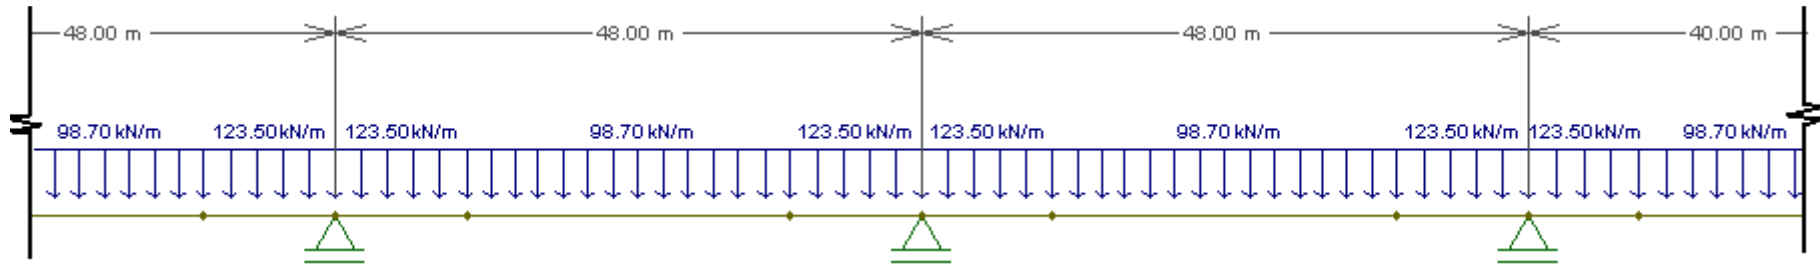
47– Aplicação das cargas permanentes no troço do perfil longitudinal
